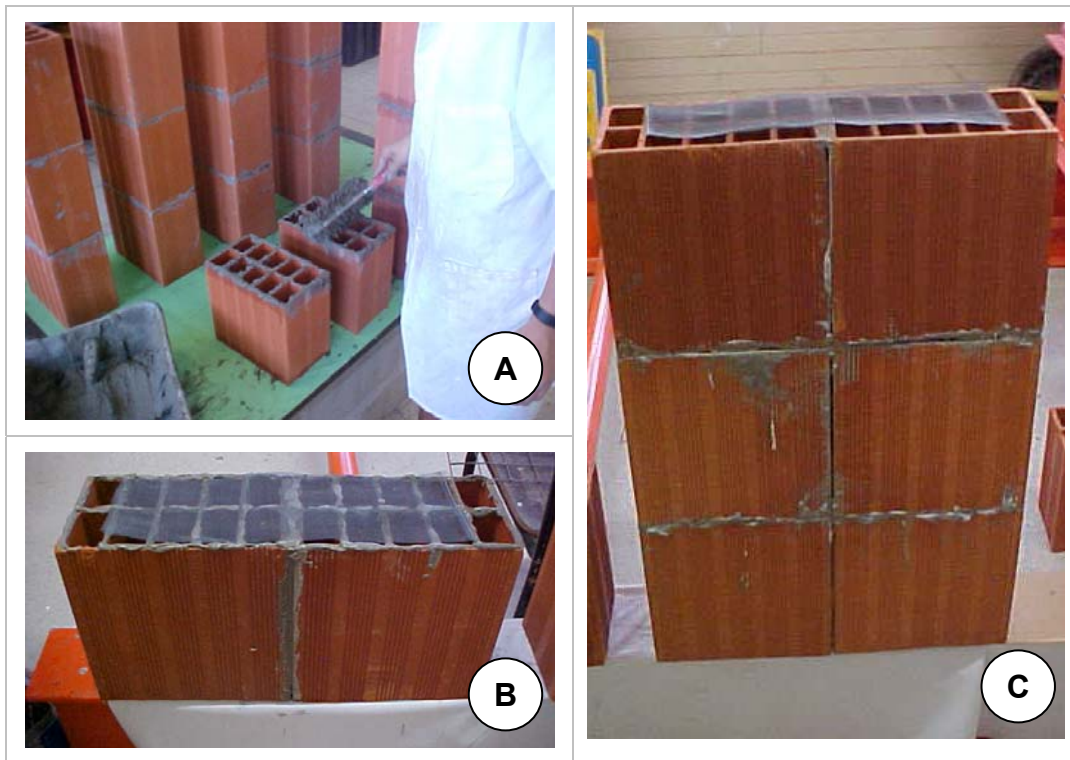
(A) Aplicação da argamassa com rolo e (B e C) Tela metálica sendo posicionada (Fonte: acervo próprio)
